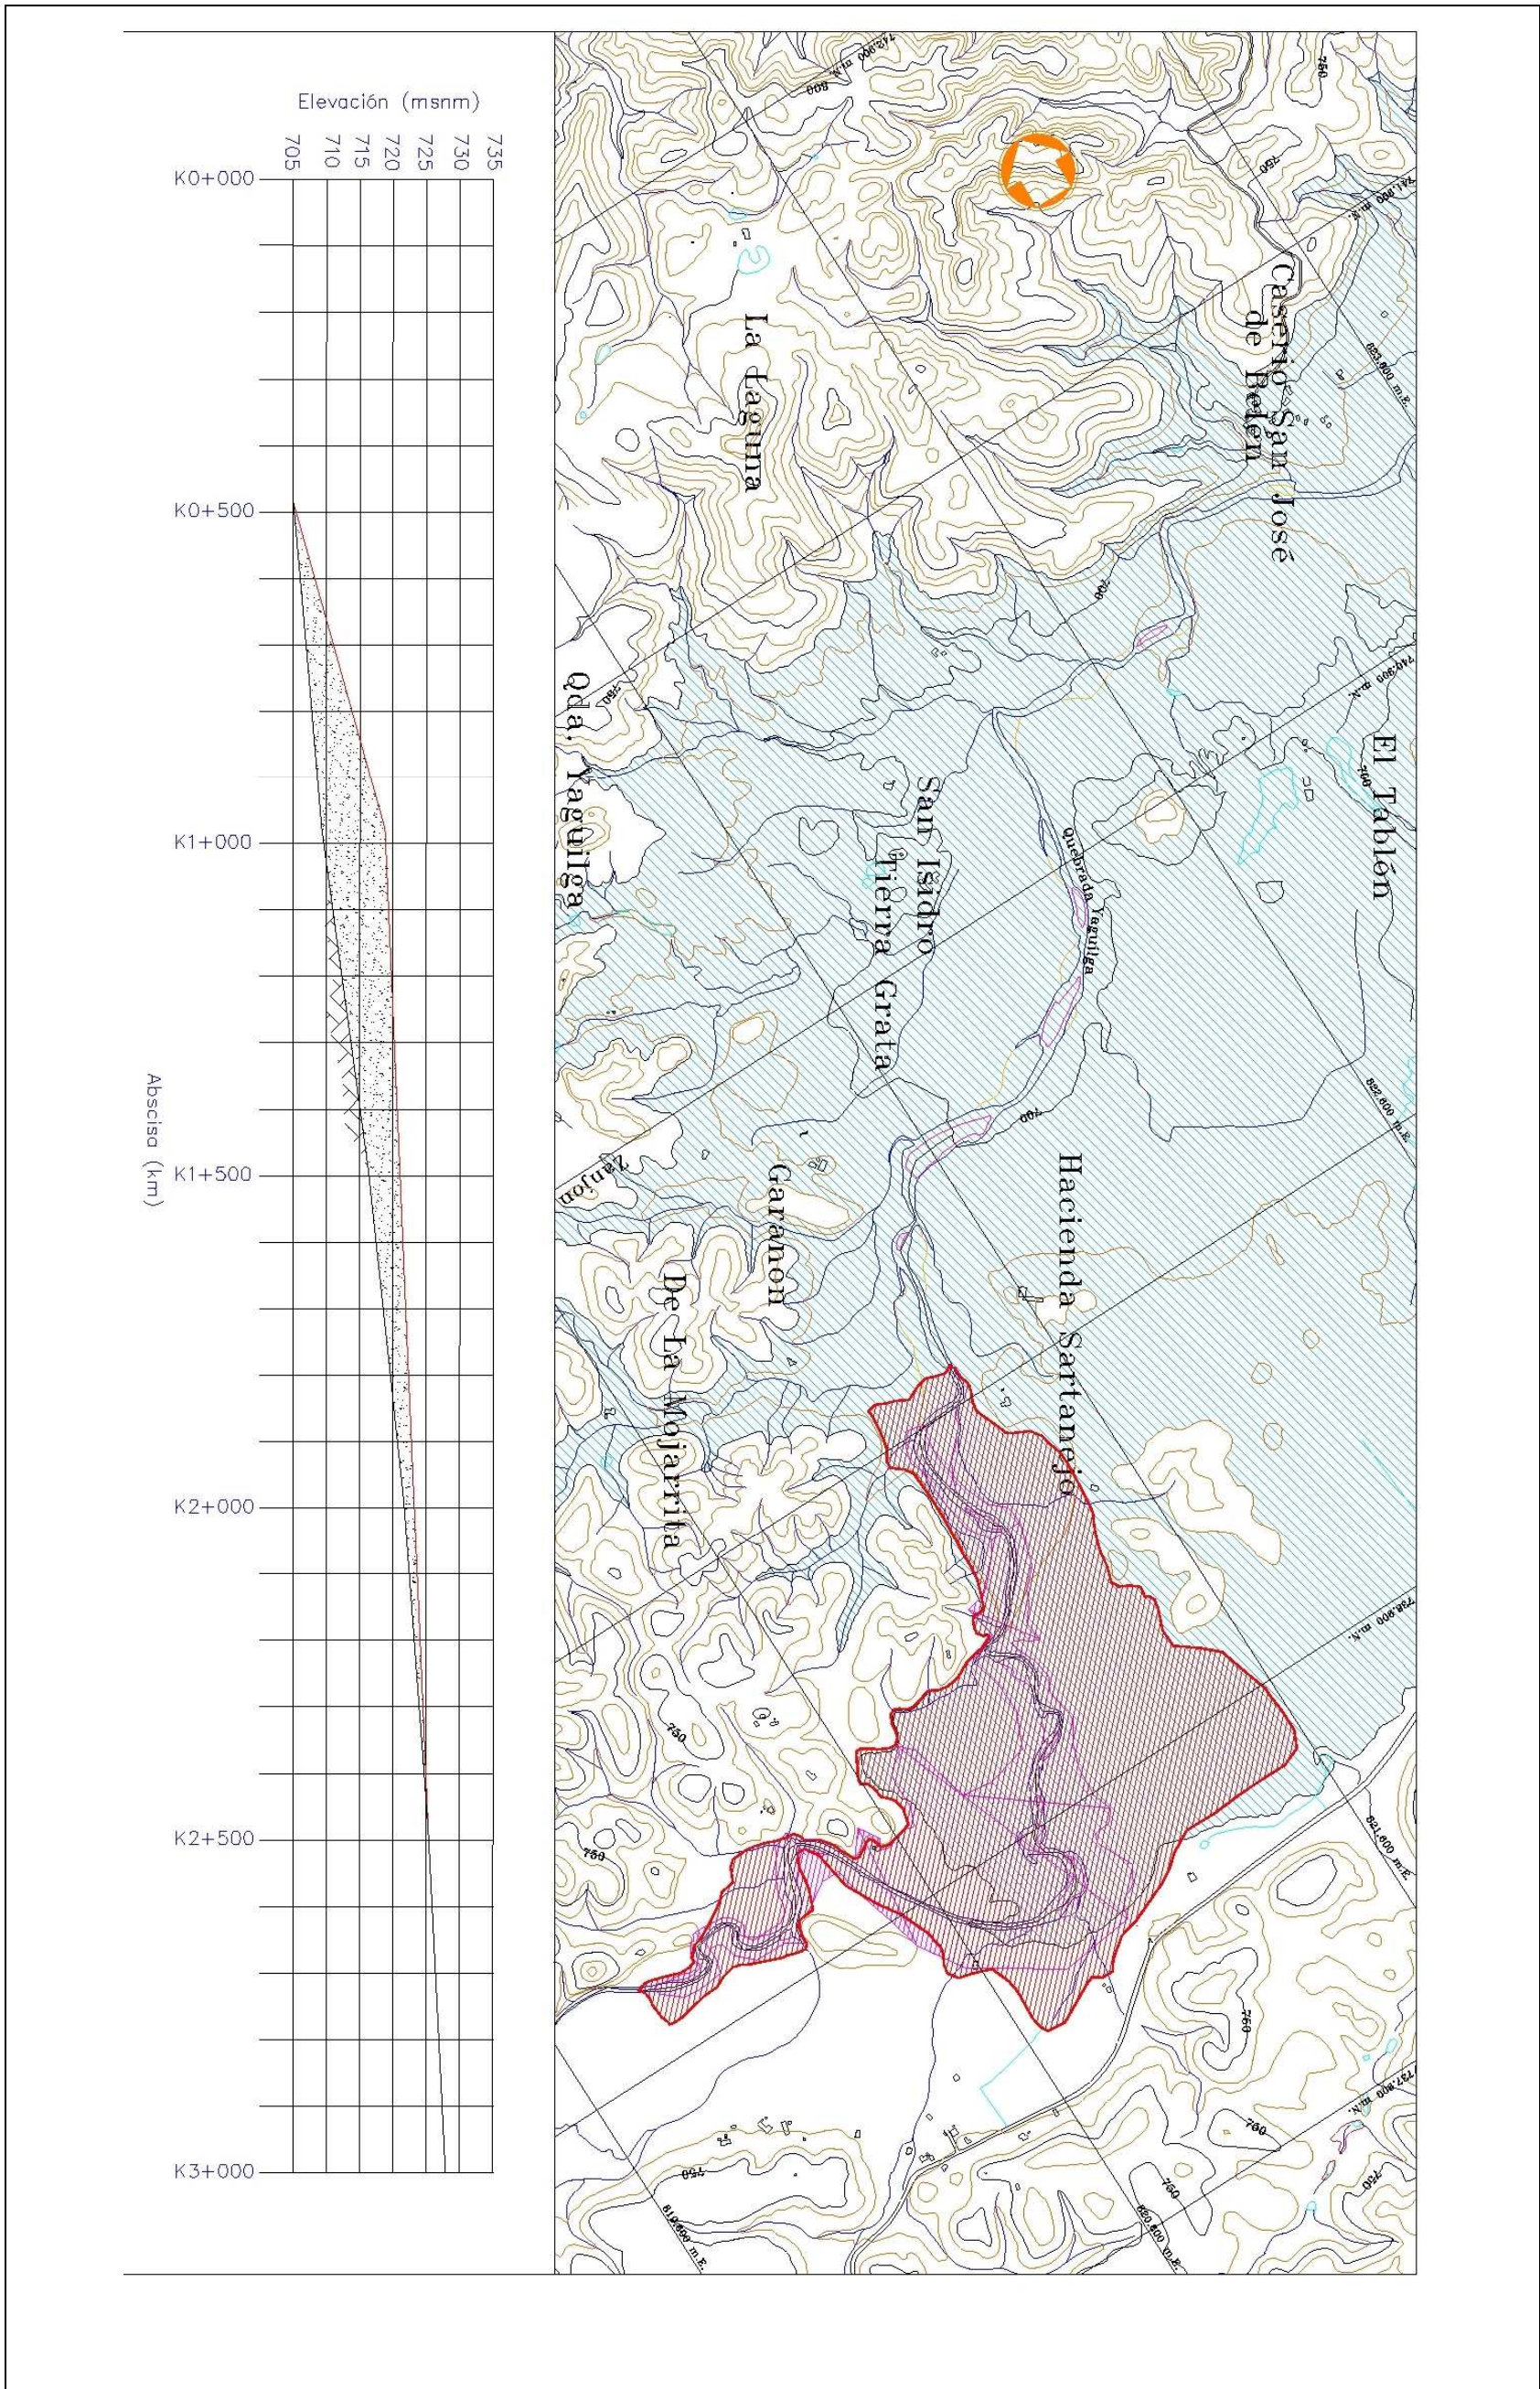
Barra de sedimento grueso Quebrada Yaguilga, Planta y Perfil
